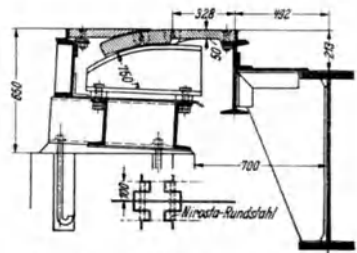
Fahrbahnübergang mit Gleitschürze (DEMAG). Nach G. BLICK: Stahlbau 11 (1938) S. 183.
